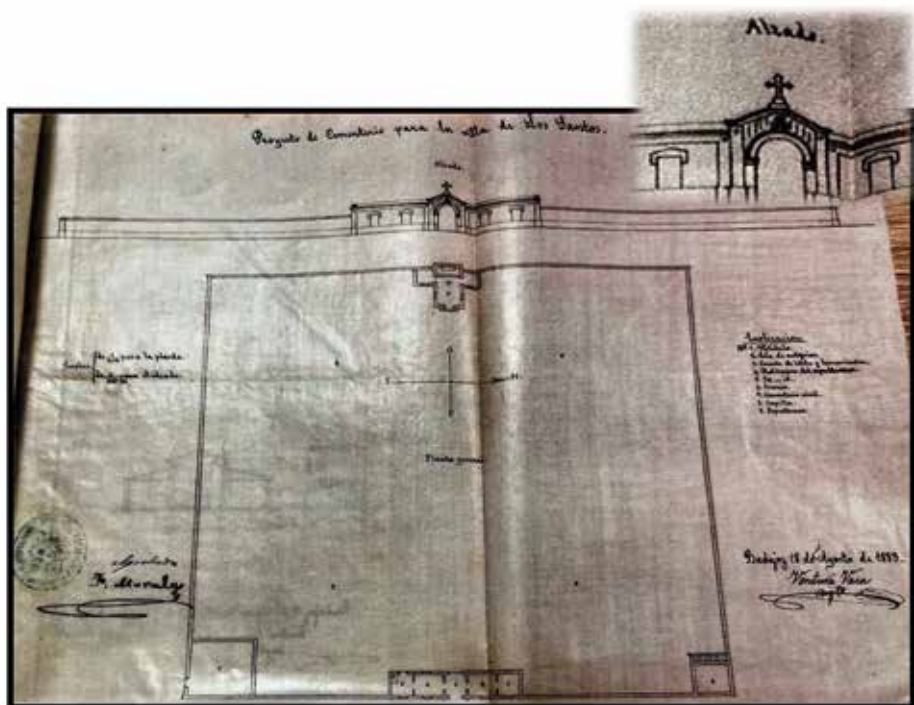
Plano de la planta general. Agradecimiento por su amabilidad en la búsqueda y escaneo de los planos a la archivera municipal de los Santos de Maimona, Doña Penélope Rubiano Montaña y al secretario del Ayuntamiento D. José Carlos Pérez Durán por la remisión de los mismos.
